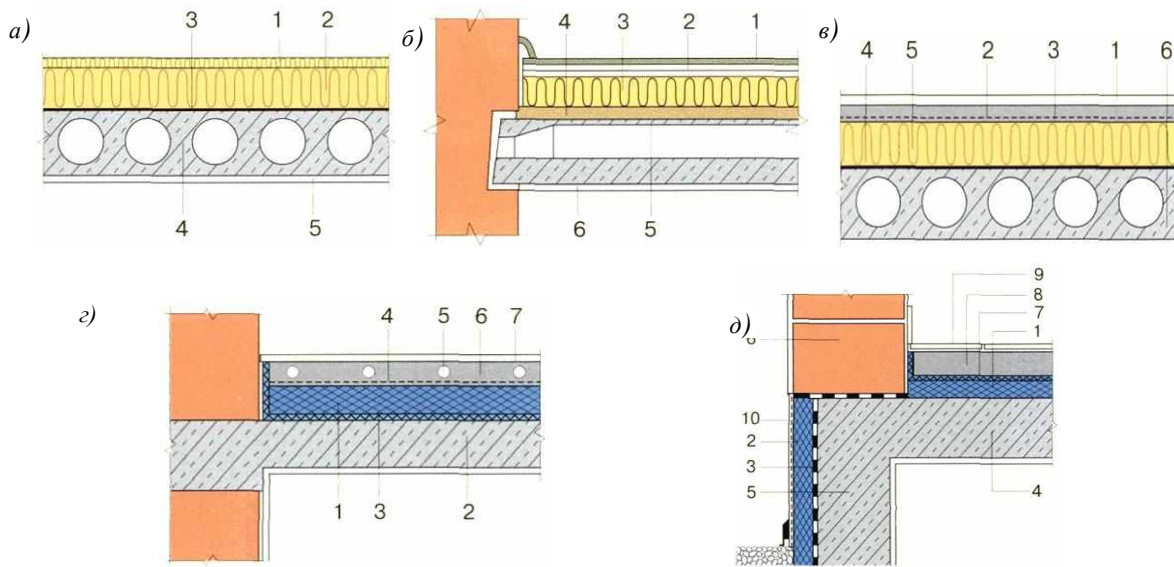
Конструкції вузлів по перекриттю: *а* – горішнє перекриття (1 – скловатна плита RKL – 30 мм; 2 – скловатна плита KL – 125 мм; 3 – поліетиленова плівка; 4 – залізобетонна плита; 5 – штукатурка); *б* – міжповерхове перекриття з безшовною підлогою (1 – покриття підлоги; 2 – дерев'яно-стружкова плита – 2 шари; 3 – скловатна жорстка плита – FLO – 40 мм; 4 – піщана засипка із зв'язкою; 5 – залізобетонна пустотна плита; 6 – вапняно-цементна штукатурка); *в* – перекриття над проїздом (1 – покриття підлоги; 2 – стягування; 3 – арматурна сітка; 4 – поліетиленова плівка; 5 – скловатні плити OL-УК, OL-К – 150 мм; 6 – залізобетонна плита); *г* – міжповерхове перекриття з обігрівом підлоги (1 – екструдований пінополістирол Floomate; 2 – залізобетонна плита; 3 – екструдований пінополістирол Styrofoam; 4 – поліетиленова плівка; 5 – ogrivальні труби; 6 – стягування; 7 – покриття підлоги); *д* – перекриття над холодним підвалом (1 – екструдований пінополістирол Floomate; 2 – екструдований пінополістирол Styrofoam; 3 – гідроізоляція; 4 – залізобетонна плита; 5 – стіна підвального приміщення; 6 – стіна зовнішня; 7 – екструдований пінополістирол Styrofoam; 8 – стягування; 9 – покриття підлоги; 10 – обробка цоколя)
